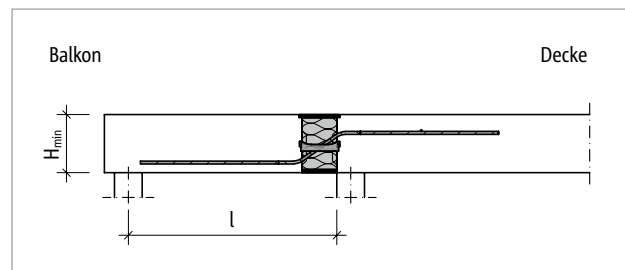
Schöck Isokorb® XT Typ QL: Statisches System (XT Typ QL-V5 bis V8)
